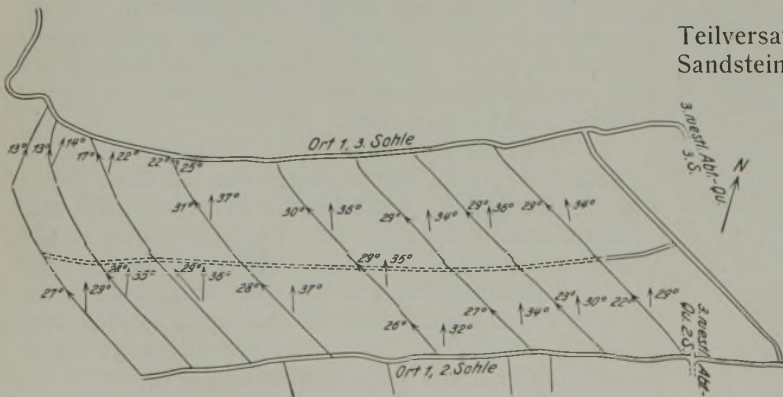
Baugrundriß des Flözes Gretchen, Schachtanlage 1/2 (Schrägbau).
